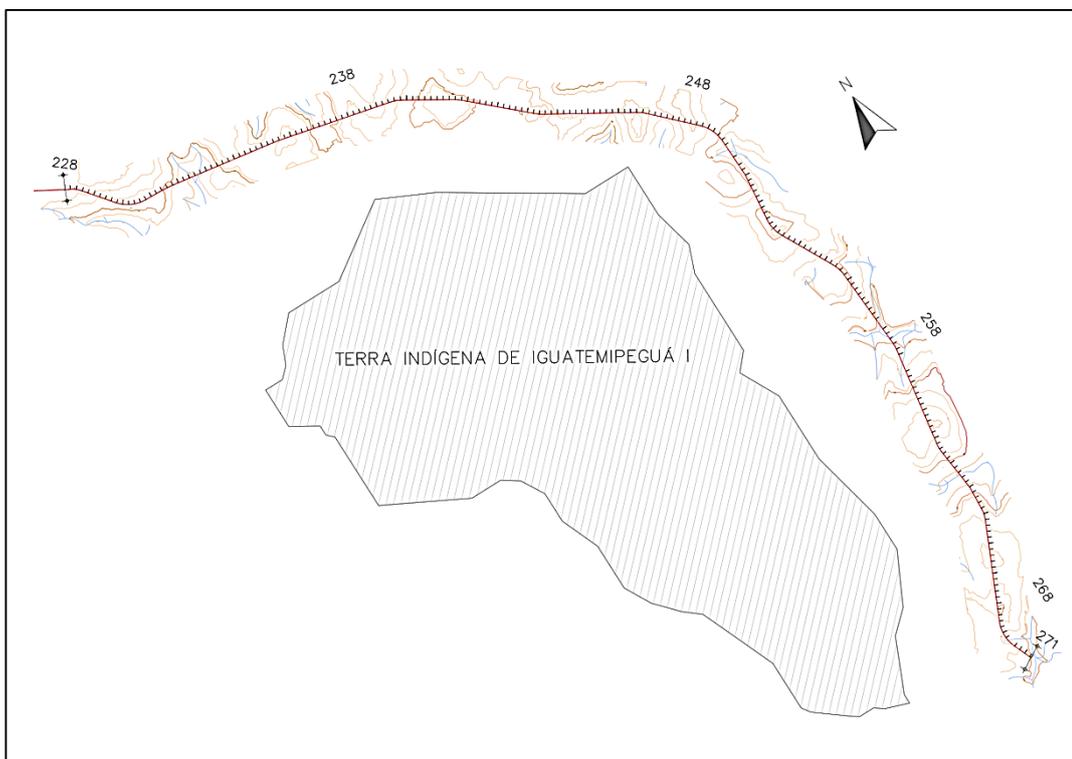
Traçado em planta do desvio proposto, entre os Km 228 ao 271.
